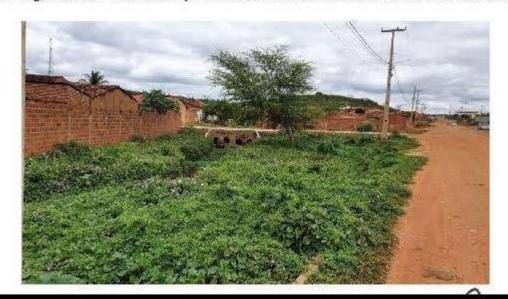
Local de lançamento das redes coletoras existente no Distrito de Socorro 1.2.2 — Outros componentes de SES
